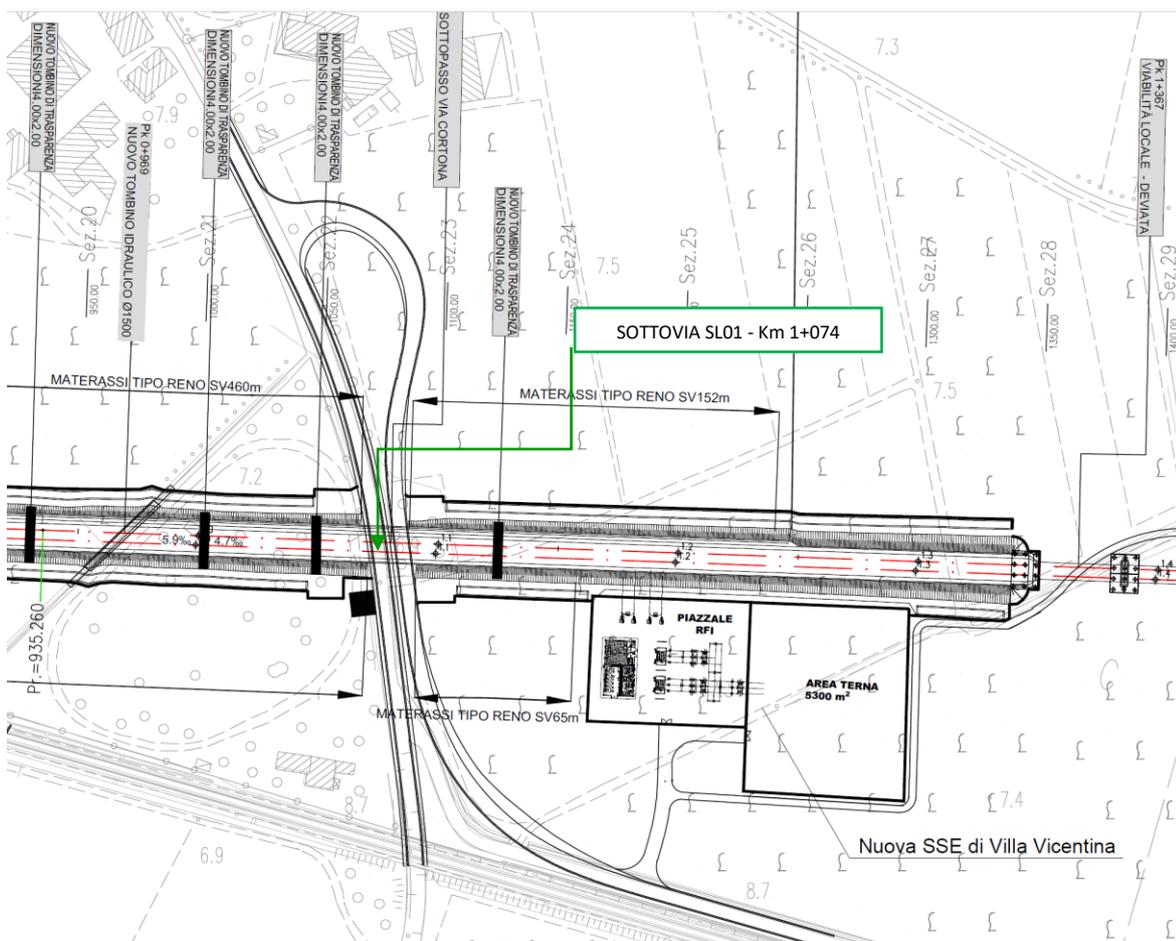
Ubicazione dell'intervento - Stralcio planimetrico
